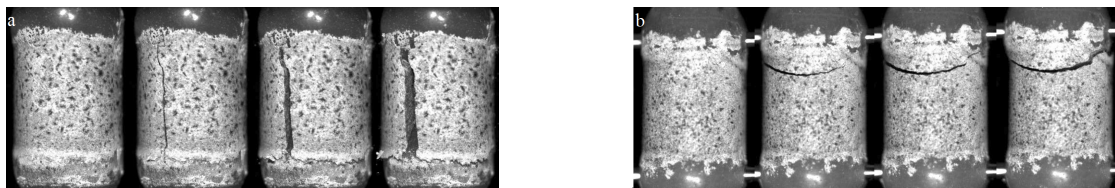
Modes de fissuration lors des essais de compression (a) et de traction (b).
